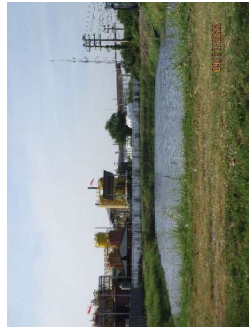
Inspection Manhole ของโรงงานในโครงการ
